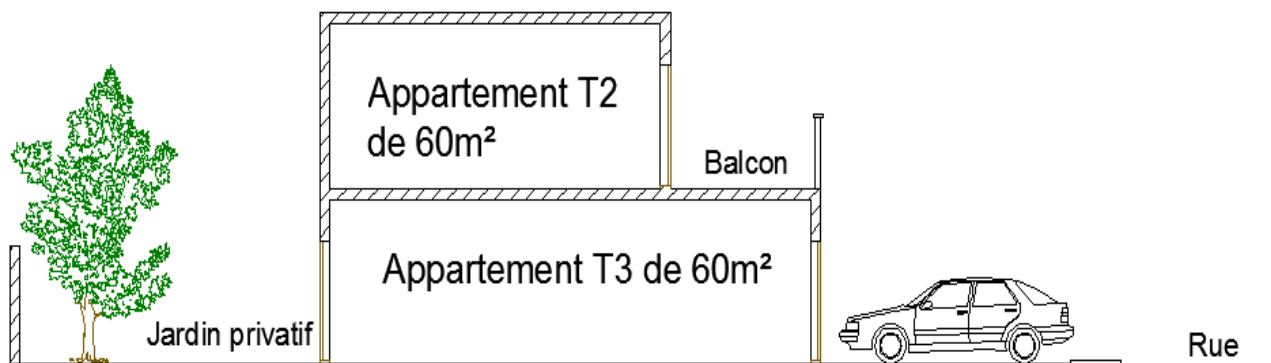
Coupe d'un des logements collectifs numéroté 1 sur le plan de masse du projet
